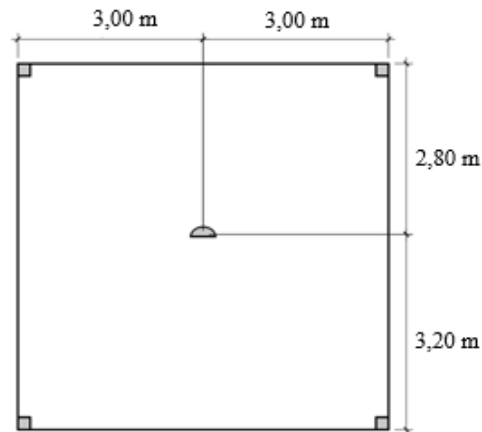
Laje lisa com pilar central de seção semi-elíptica.
